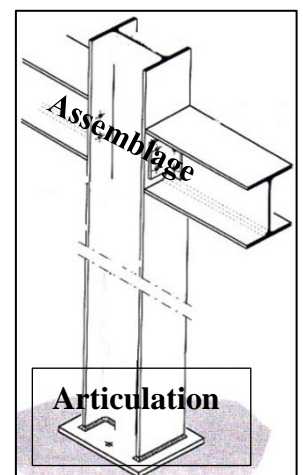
Assemblage des poteaux et des poutres métalliques. Source : charpente.ooreka.fr
